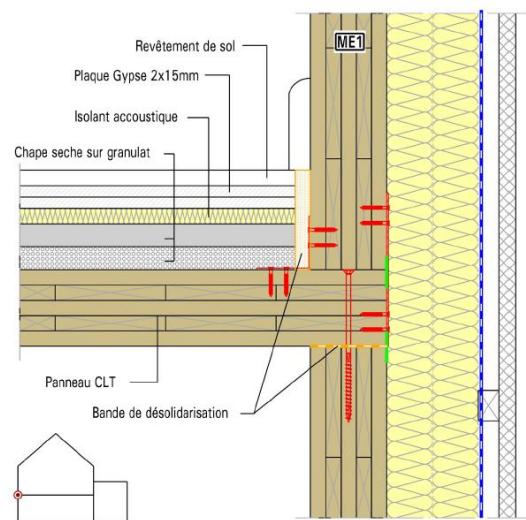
Liaison plancher intermédiaire avec murs CLT
